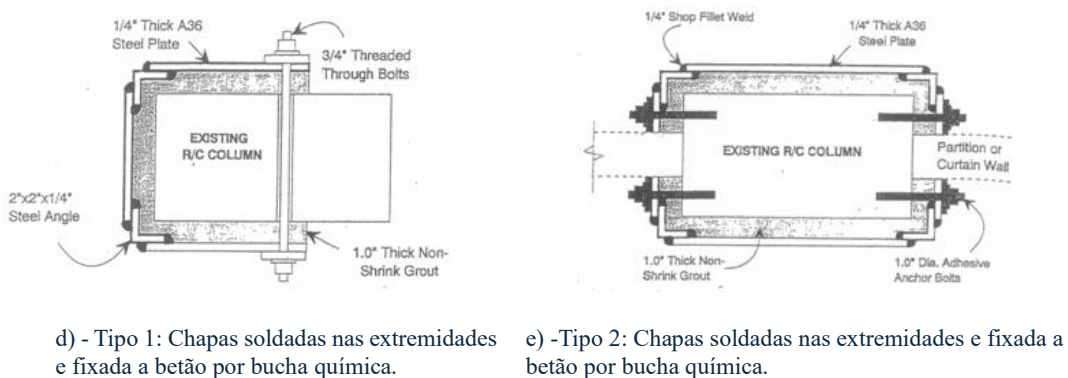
Encamisamento parcial de pilar com chapas metálicas (17).
